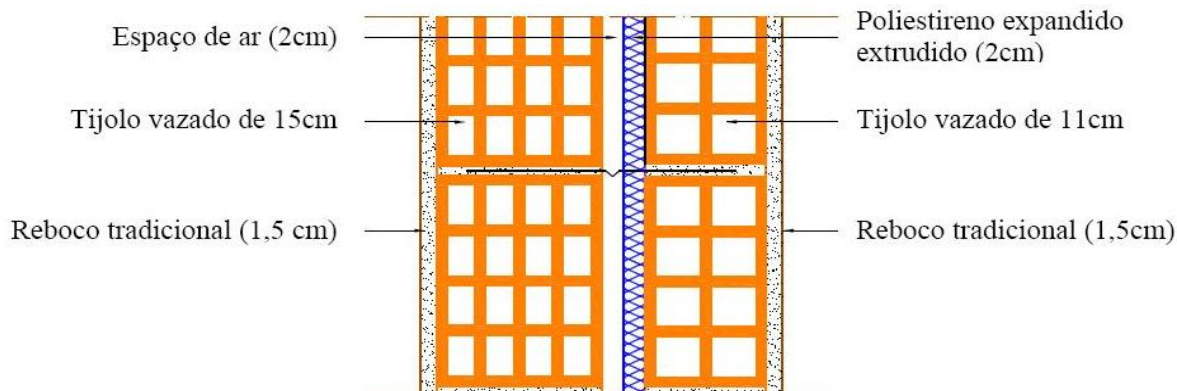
Parede dupla em alvenaria de tijolo vazado [13]
